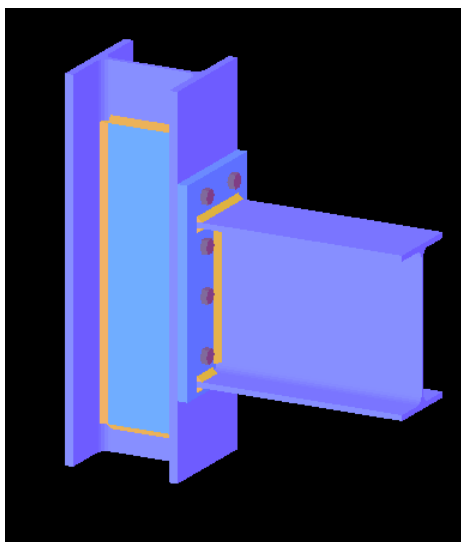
Ligação reforçada com chapa de alma no pilar
